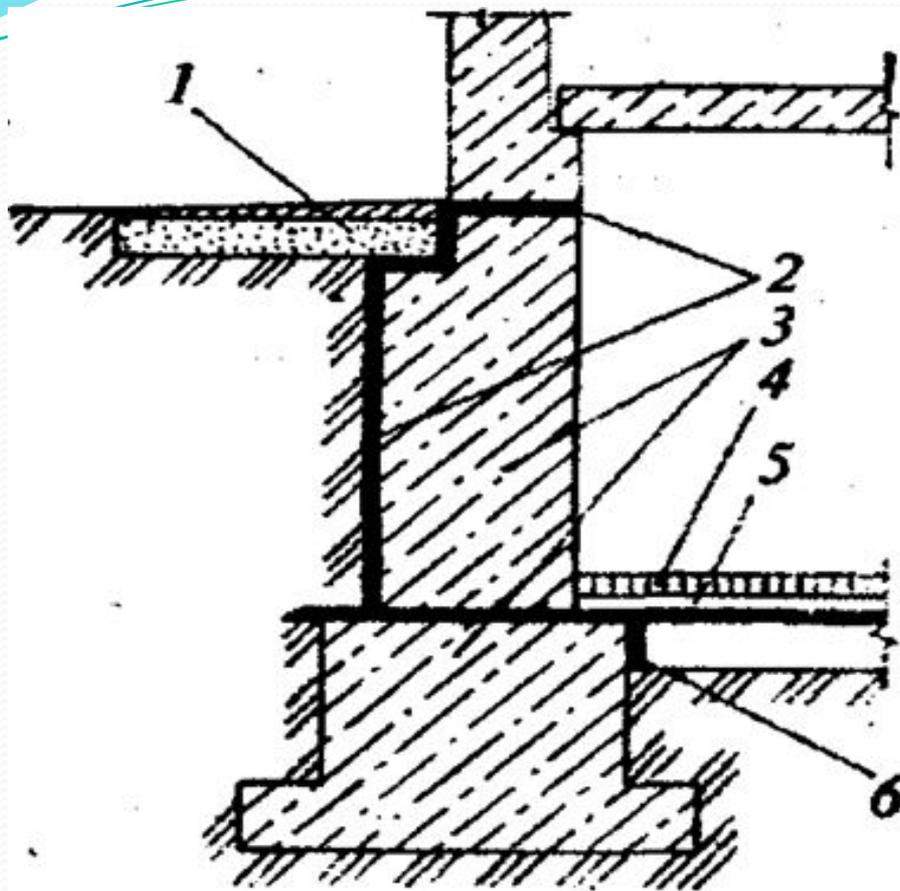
Гидроизоляция фундаментов от капиллярной влаги:
